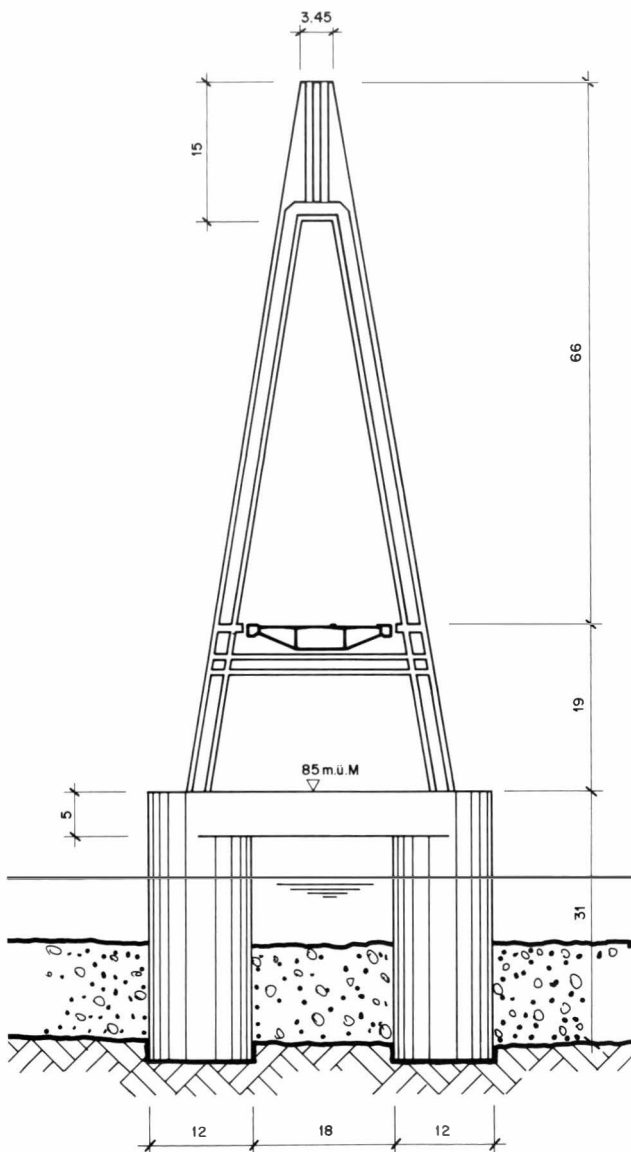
Ansicht des Pylons (Masse in m) – Le pylône en élévation (dimensions en m) – Elevation of the pylon (Dimensions in m)
